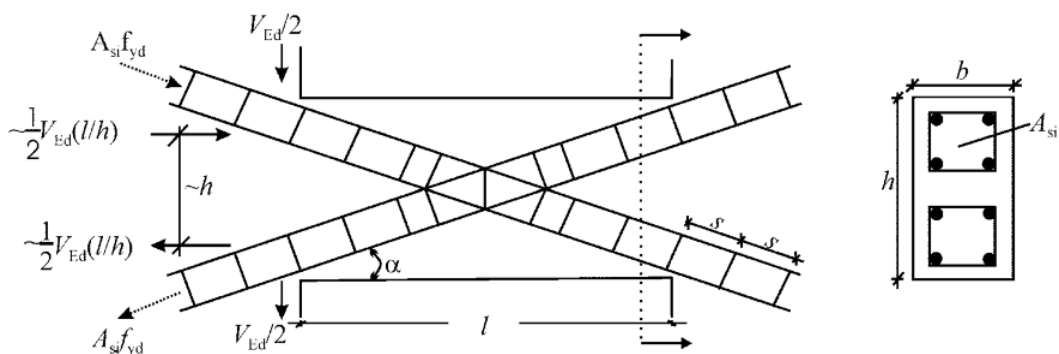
Vigas de acople con refuerzo diagonal (Fuente: EC-8)
